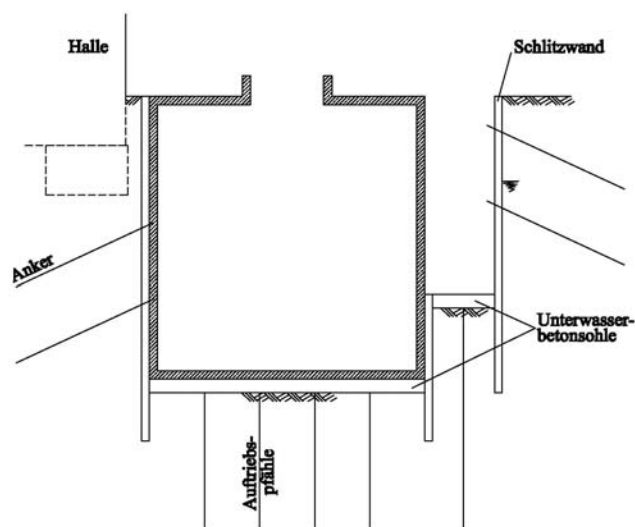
Schnitt Baugrube Sinterbrunnen und Pumpenraum
